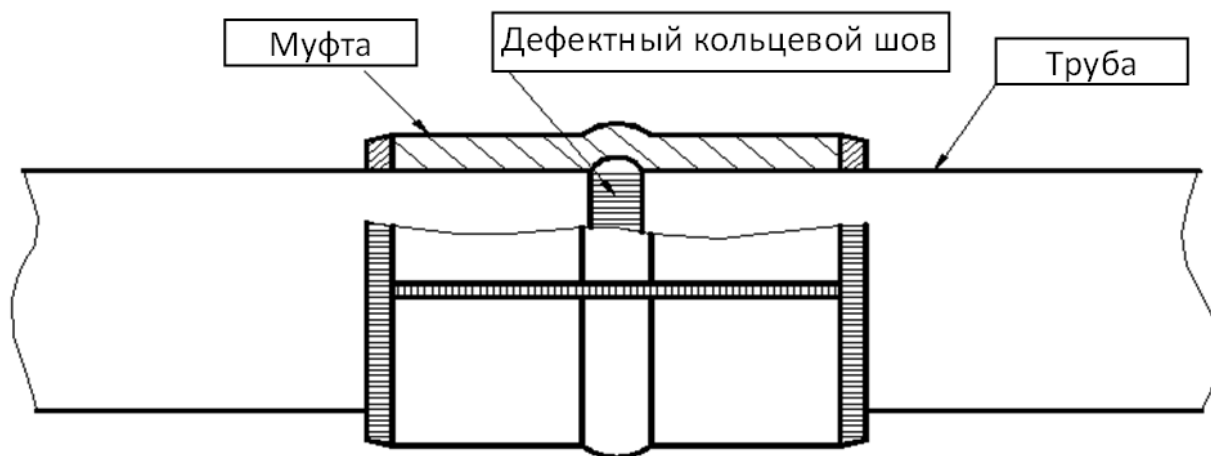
Муфта галтельная приварная для ремонта сварных кольцевых
